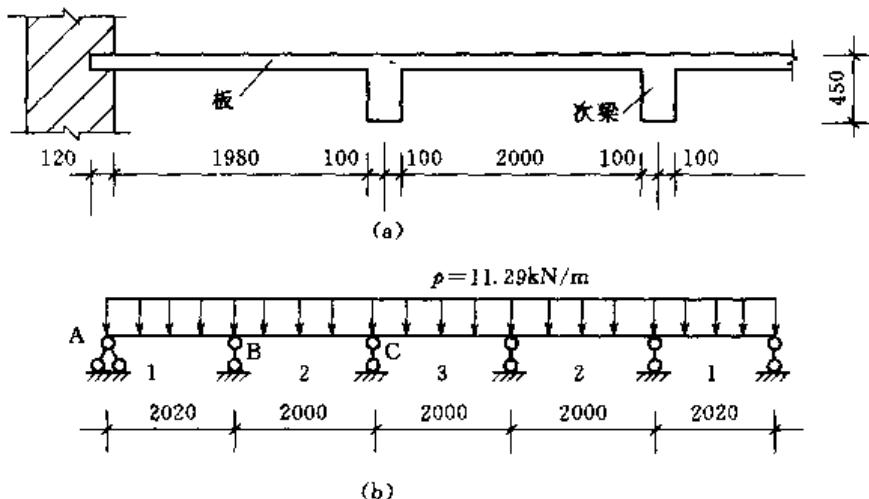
板的支承情况及计算简图 (单位: mm)
